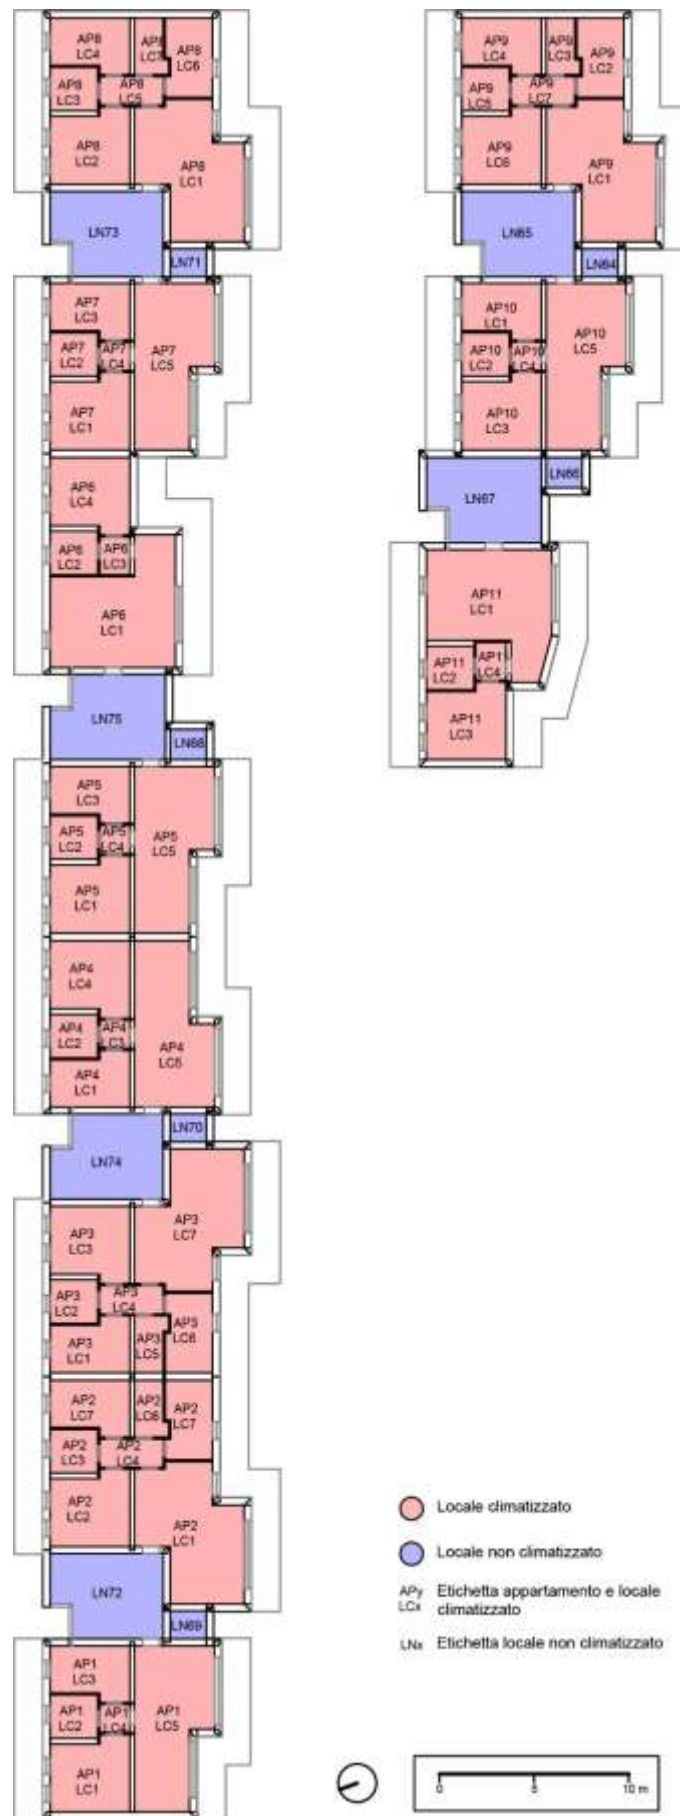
Pianta P01 dei locali di Edilclima [Fonte: elaborazione dell'autore]
